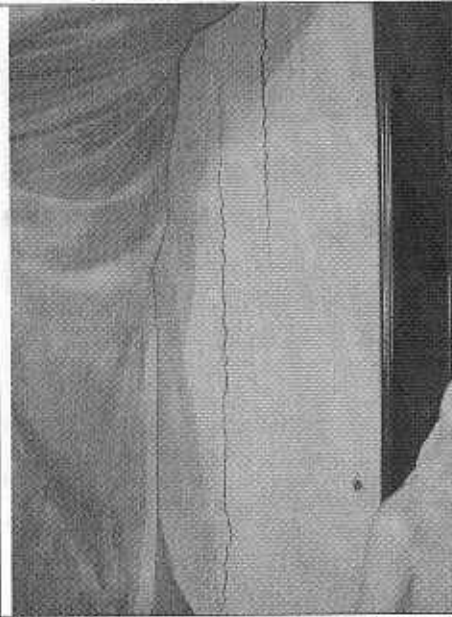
Grietas de tendencia vertical en el punto de contacto entre los muros de la ampliación (izquierda) y la construcción original (1er nivel).
